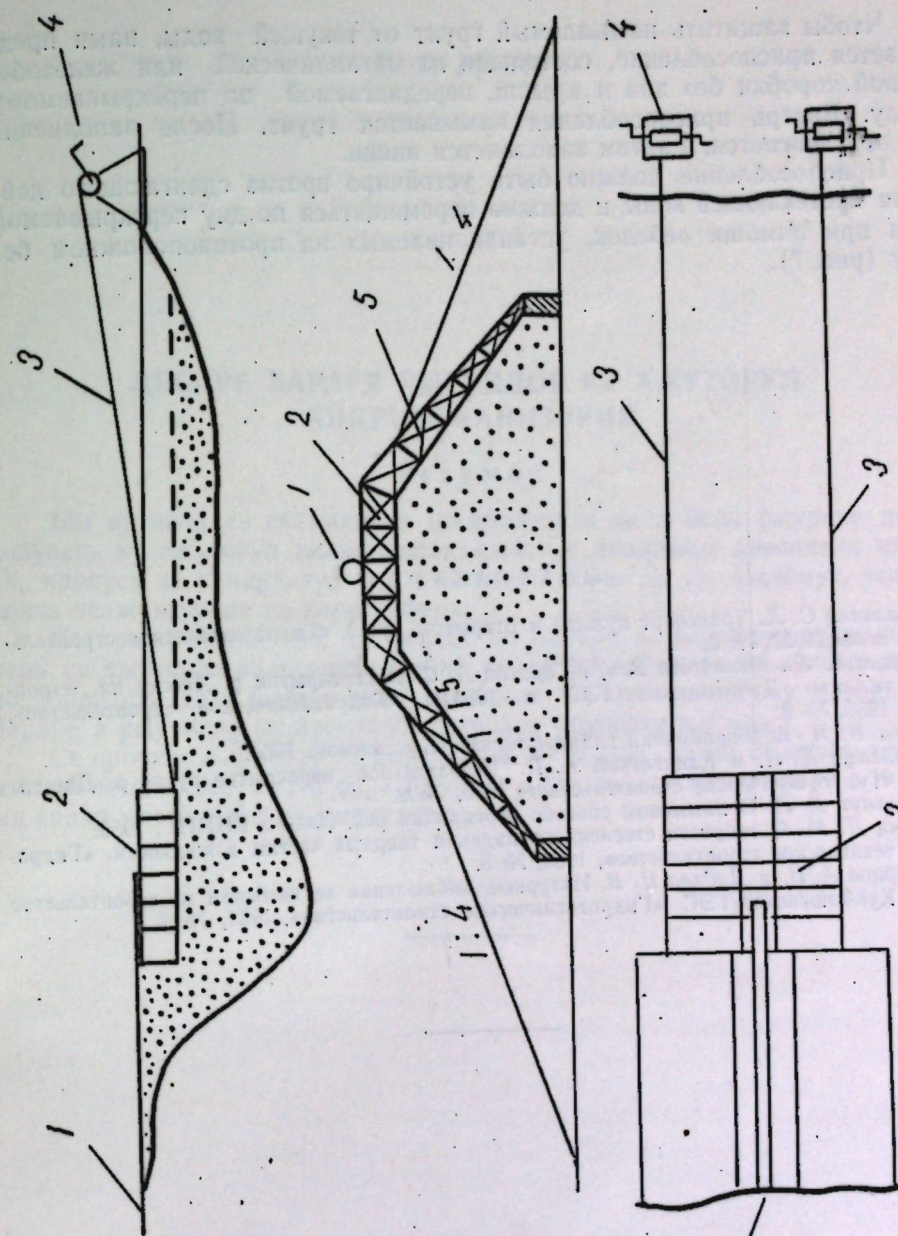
Приспособление для перекрытия русел рек намывным способом (продольный и поперечный разрезы, план):
